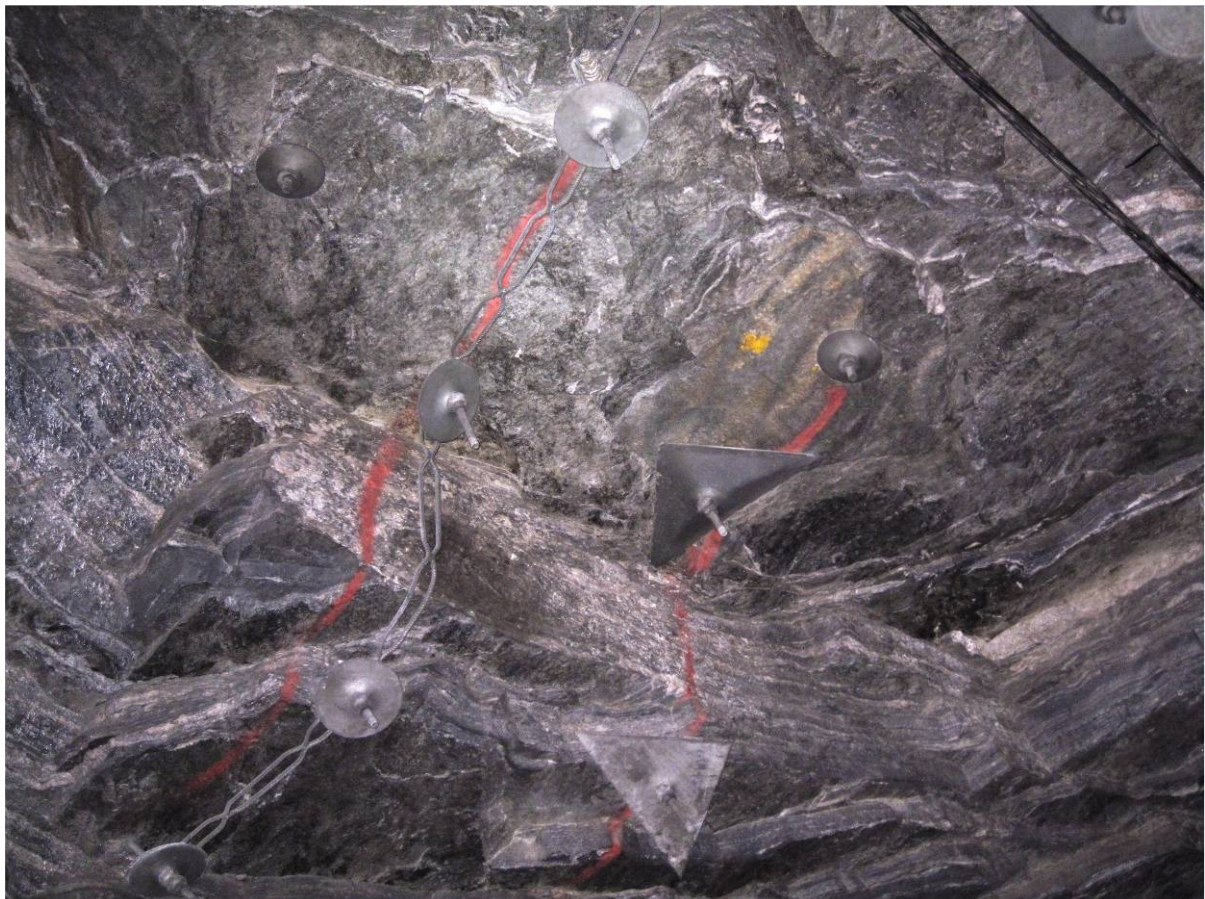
Gammel boltetype, korrodert svartstål. Vabler på bolteplate
